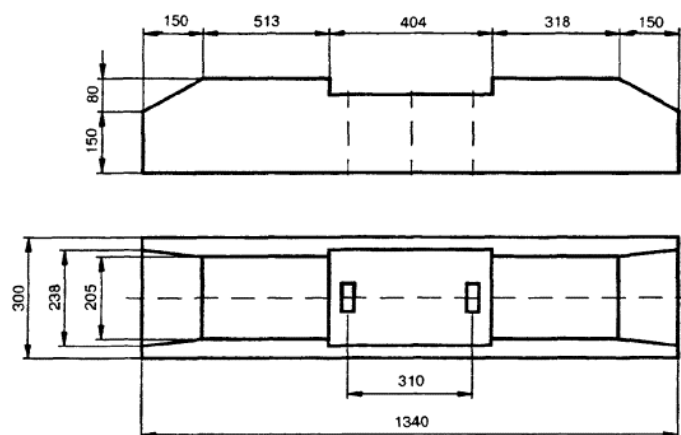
Железобетонная полушпала ПШН1-13-325-1
